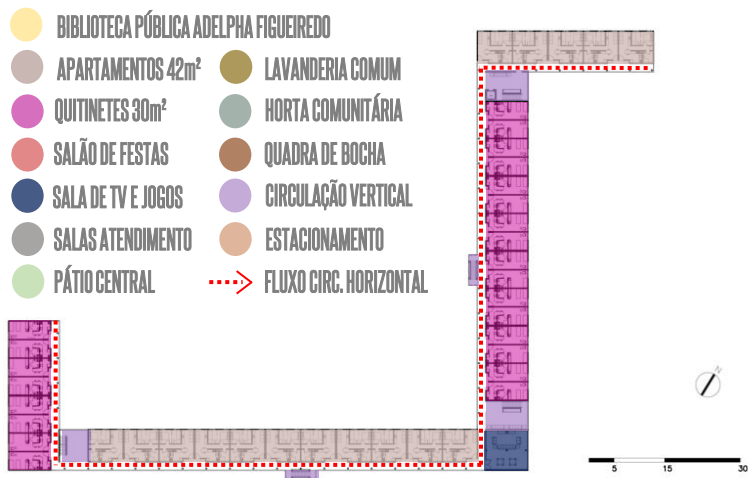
Planta primeiro pavimento com setorização. Fonte: Vigliecca. Esquema elaborado pela autora. 2020.
